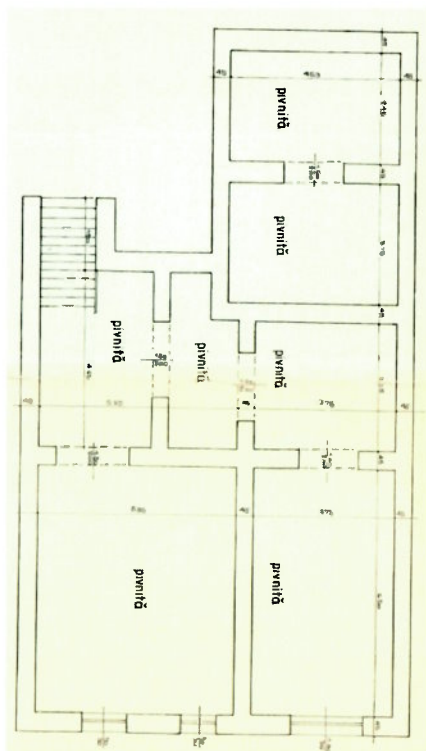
Plan subsol – relevu 1993 (ing. P. Tudose) Sursa: arhiva Exprosecon
